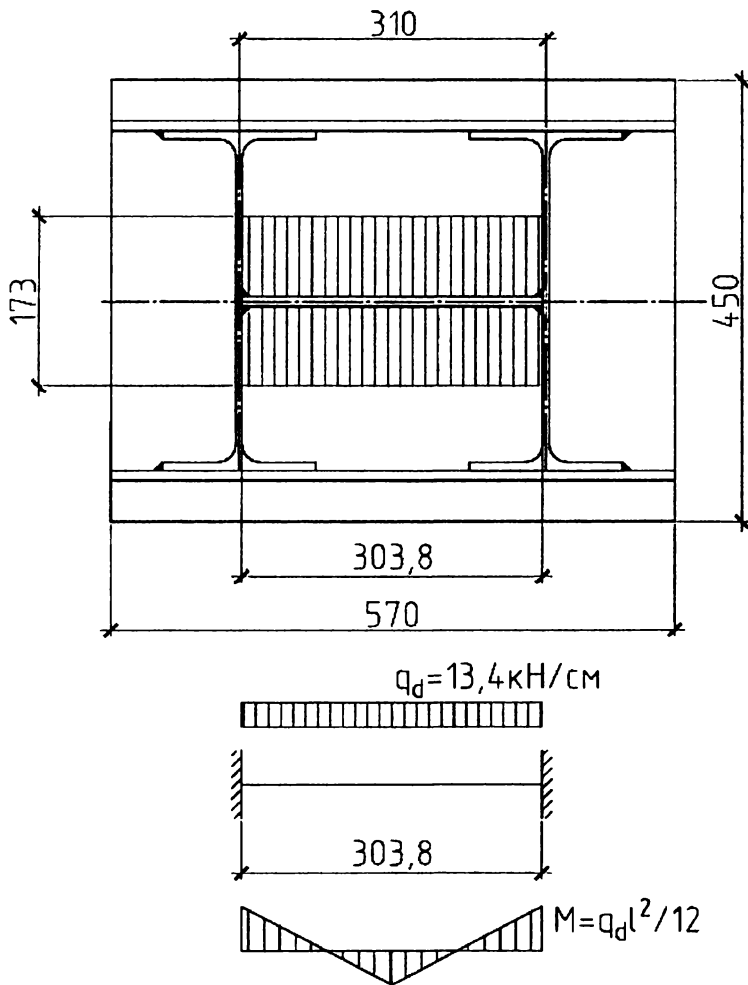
Грузовая площадь для расчета диафрагмы и расчетная схема
